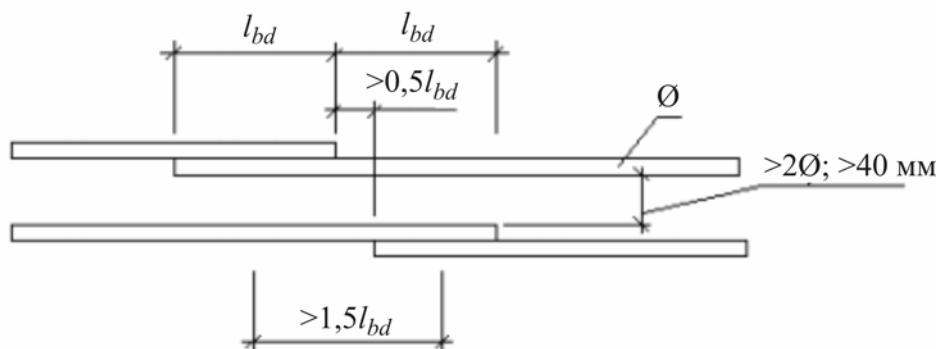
Схема соединения стержневой арматуры без сварки
